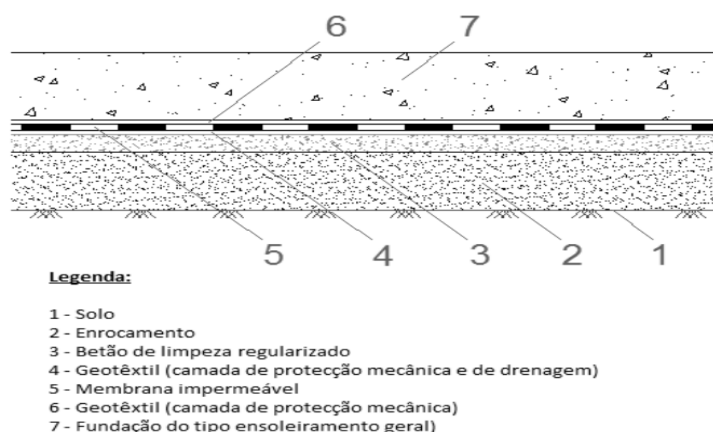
Sistema de impermeabilização pela face inferior de um ensoleiramento geral (Mendes, 2011).
